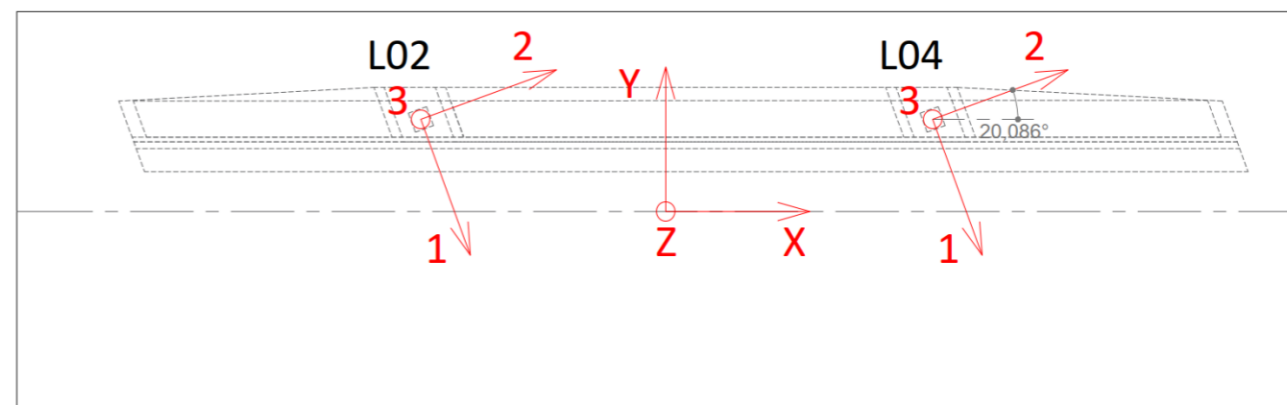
Definición de las bases de ejes locales de la zapata y de los nudos de las vigas longitudinales (fuente: elaboración propia)
